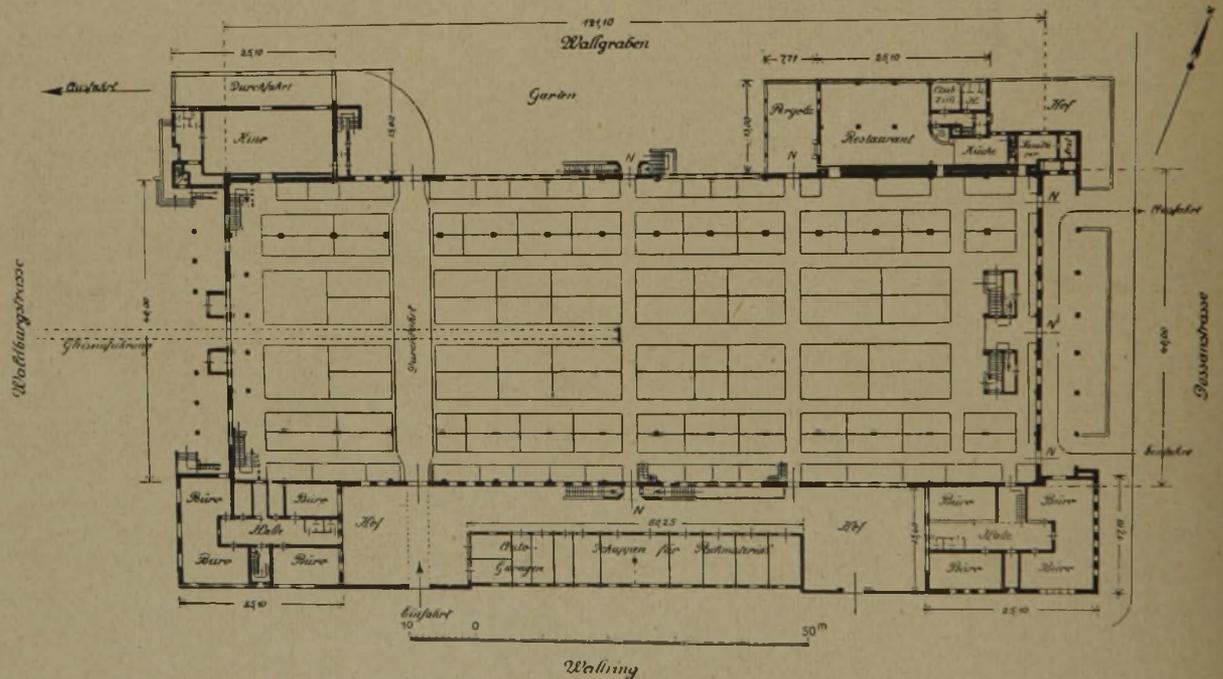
Grundriß des Erdgeschosses (rd. 1:1200).
